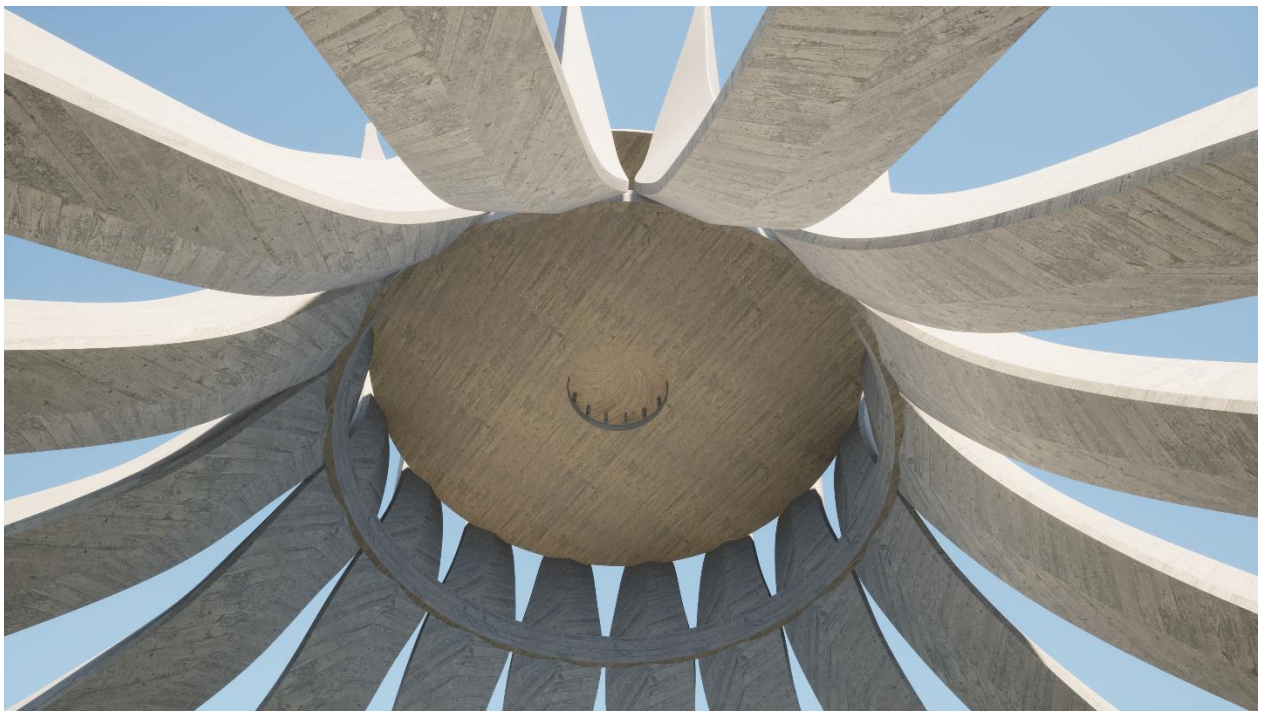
Detalhe da laje circular de cobertura e anel de compressão. Fonte: Autorial.
